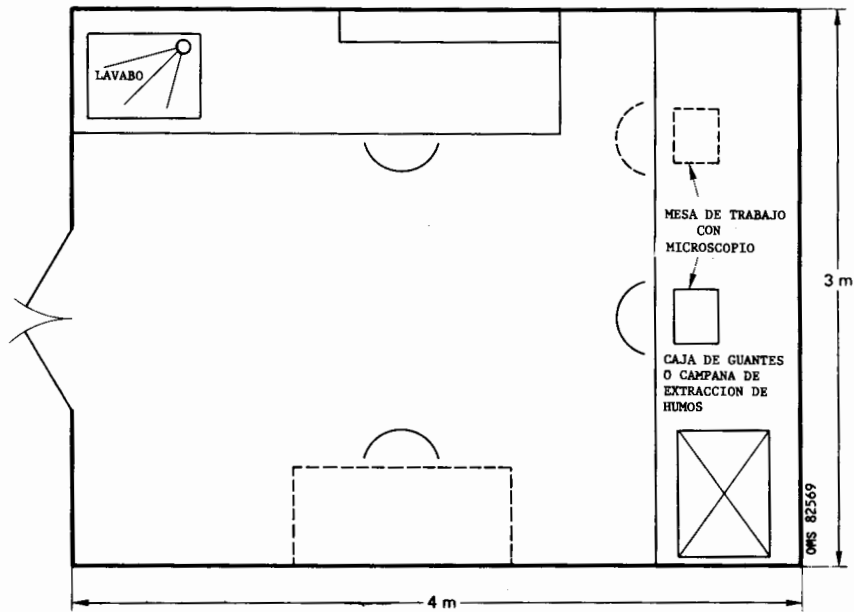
PLAN DE UN LABORATORIO DE CENTRO DE SALUD
